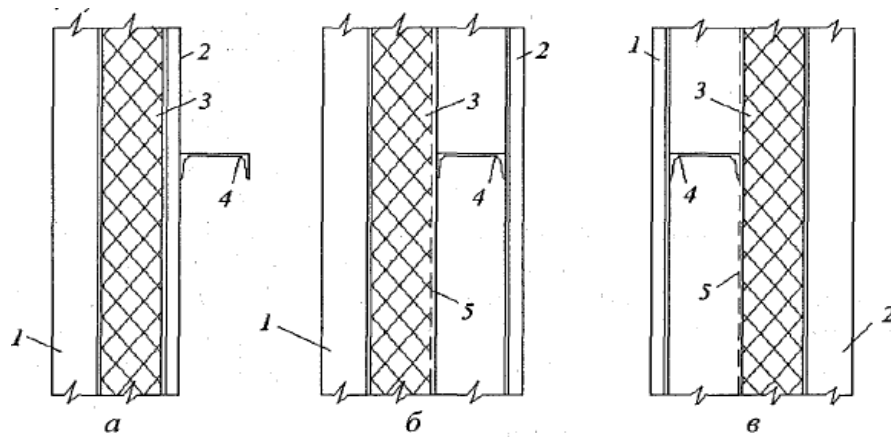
Конструкції утеплених стін із пошаровим монтажем: 1, 2 – відповідно зовнішня і внутрішня обшивки; 3 – утеплювач; 4 – ригель фахверка; 5 – монтажна сітка
